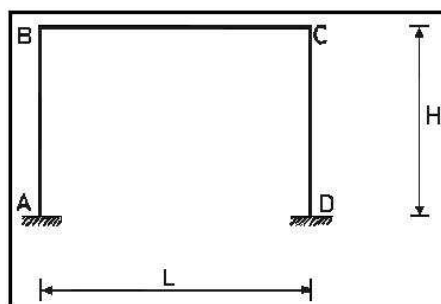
Pórtico plano con elementos totalmente flexibles.
